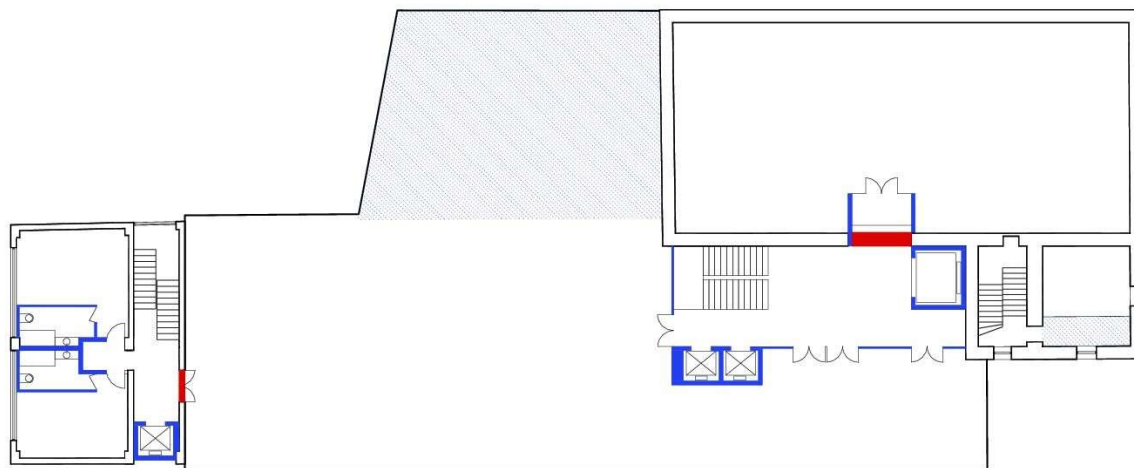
Prizemlje - shema rušenja i novih konstrukcija
